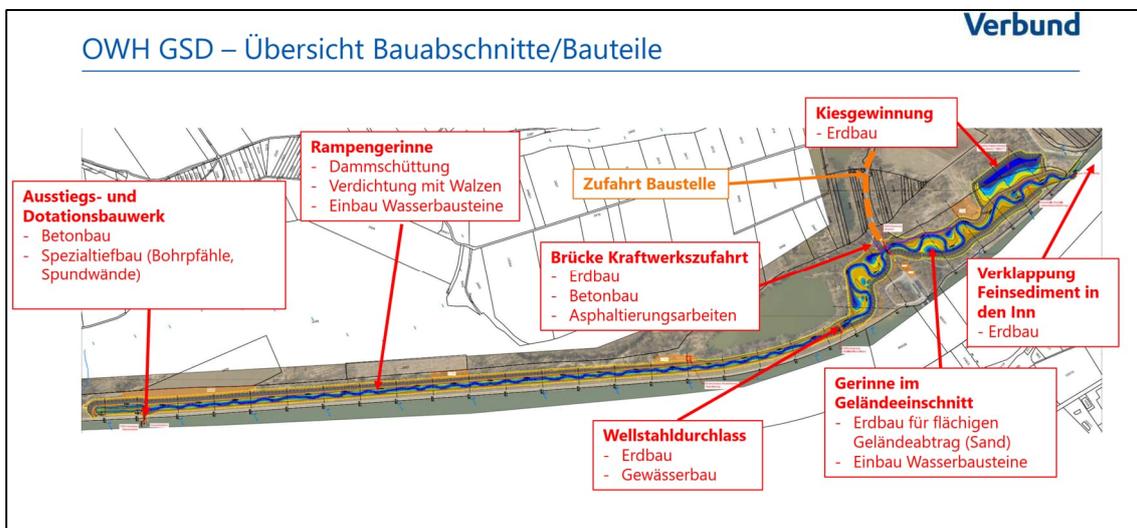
Lageplan mit Kennzeichnung der geplanten Bautätigkeiten /6/
